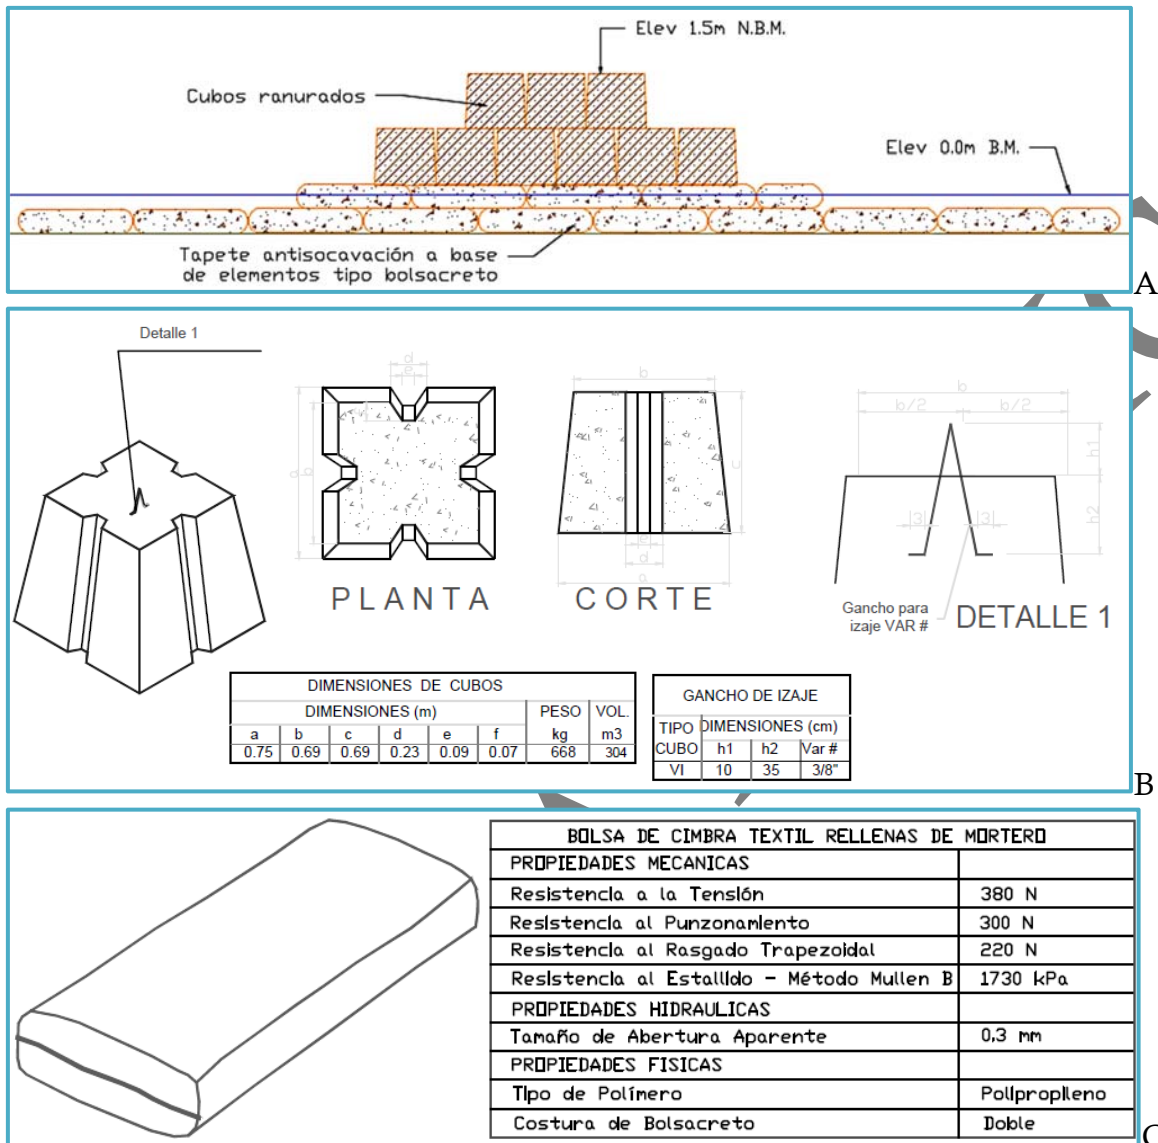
Estructura de protección tipo rompeolas. A) Sección transversal tipo, B) Detalles de cubos ranurados, C) Detalles de las bolsas de cimbra para los bolsacretos.
